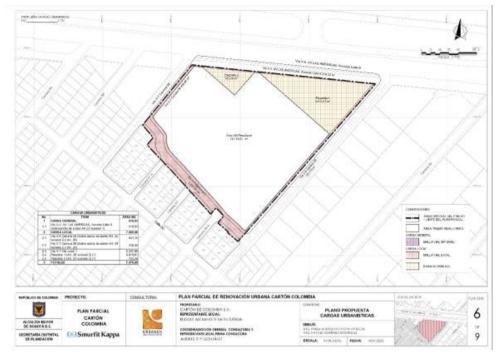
Plano de cargas generales y locales del Plan Parcial.
